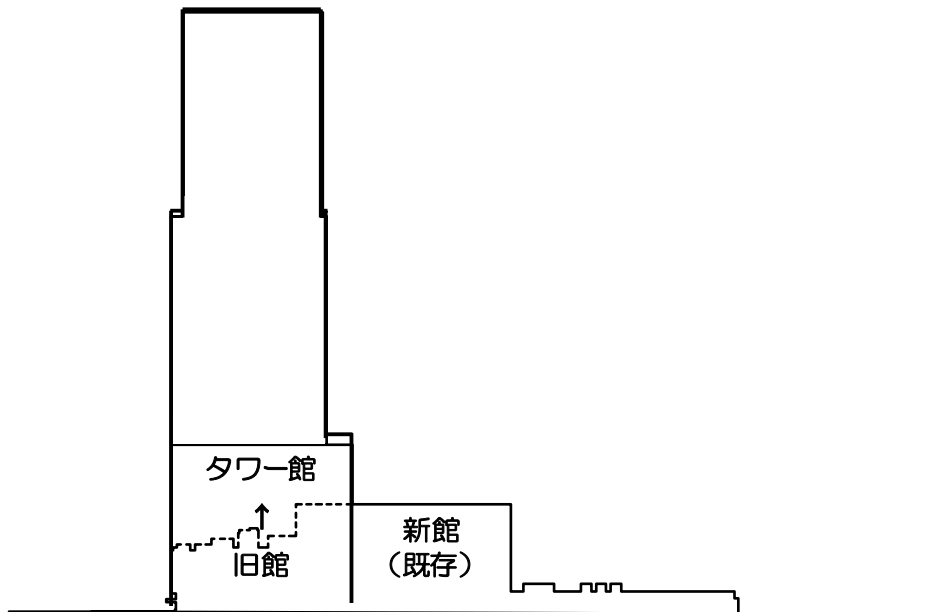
計画施設（阿部野橋ターミナルビル）概略立面図
